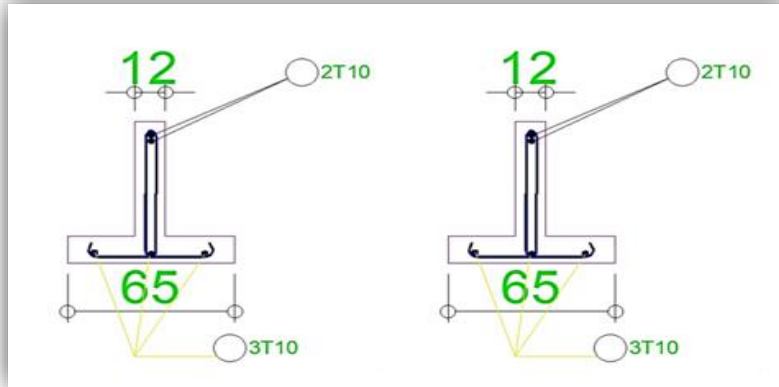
Ferrailage des poutrelles dans terrasse et étages.
